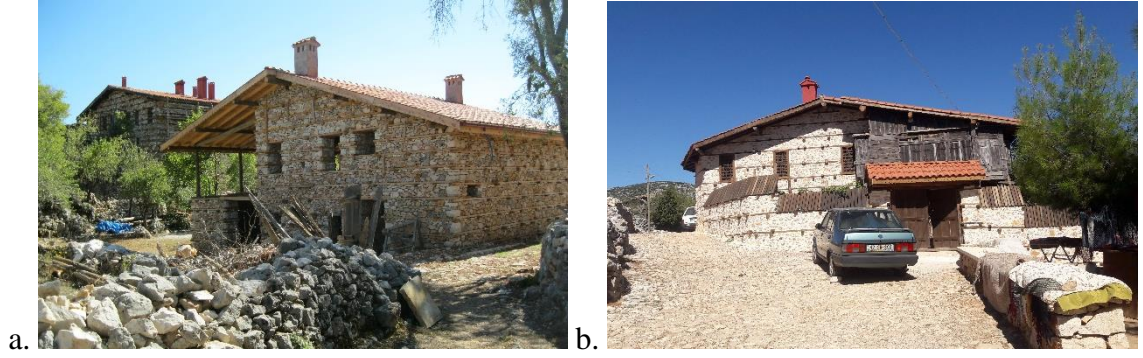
Çimi, 130 ada 3 parseldeki tescilli yapının betonarme ekleri (Orijinal 2018)
